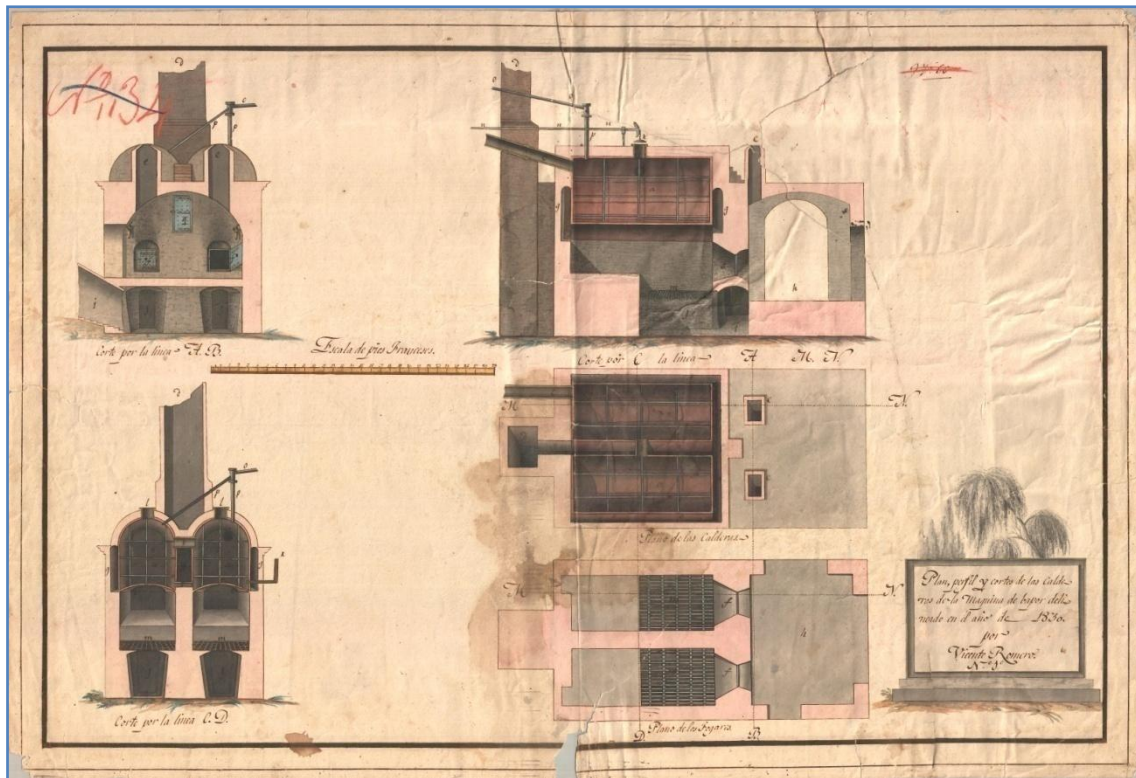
Plan, perfil y corte de las calderas de la máquina de vapor. Plano P-05429.
